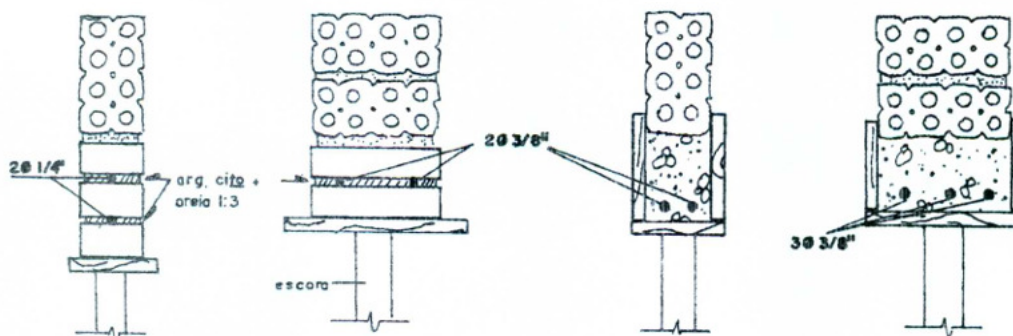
Vergas em alvenaria de tijolo furado para vãos até 1,00m e entre 1,00m e 2,00m
